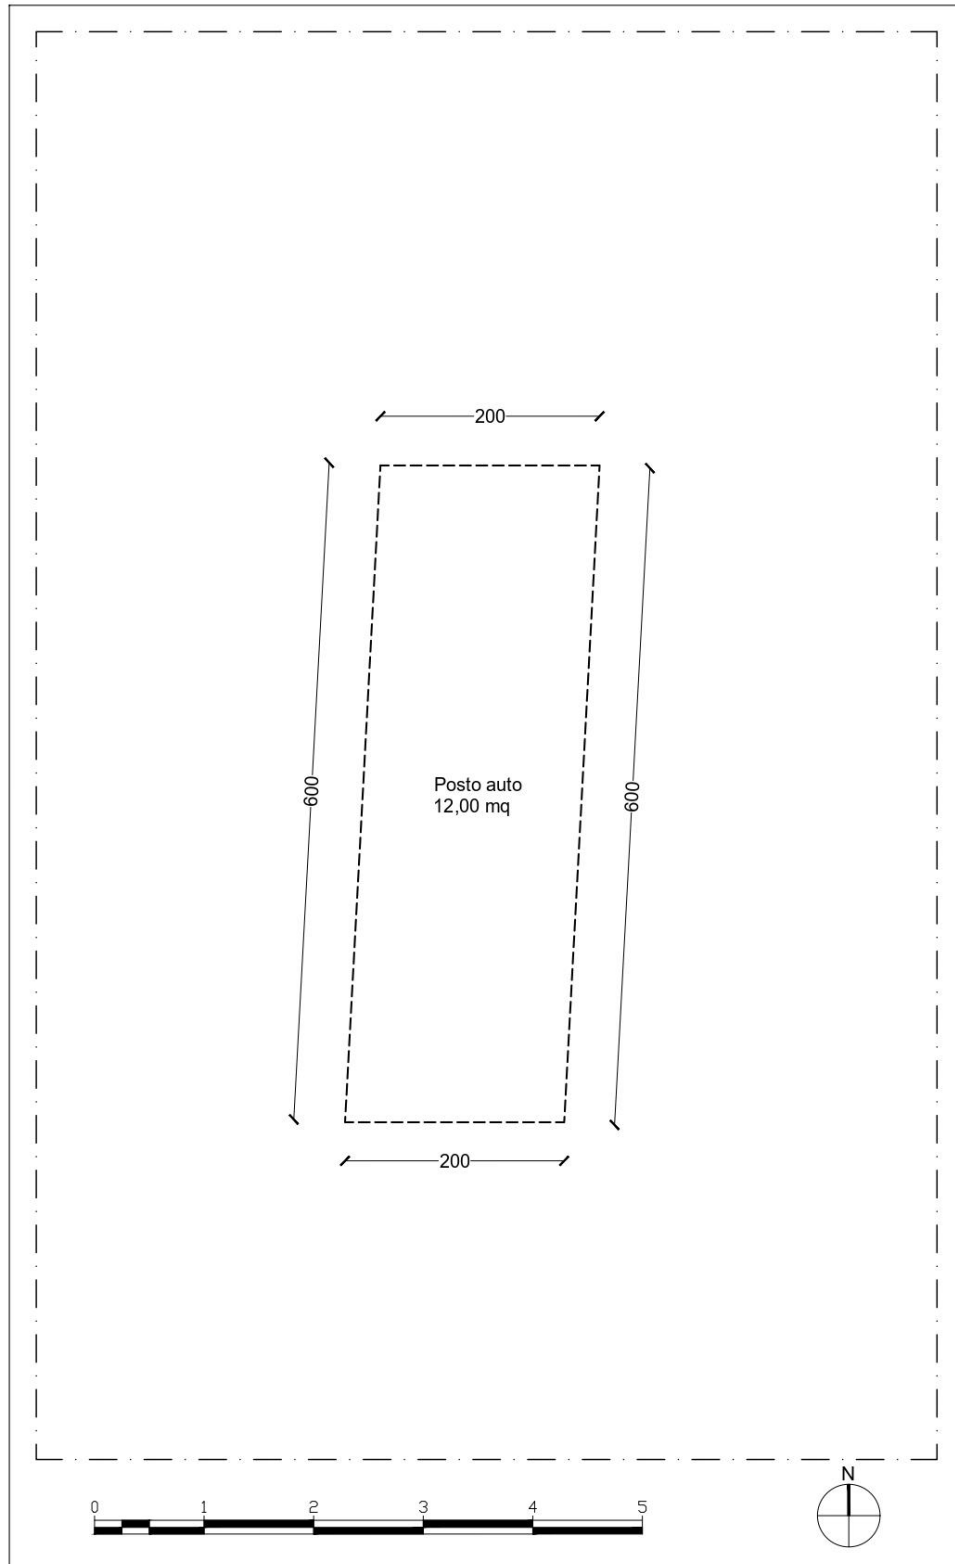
Planimetria stato di fatto – unità immobiliare oggetto di elaborato peritale
